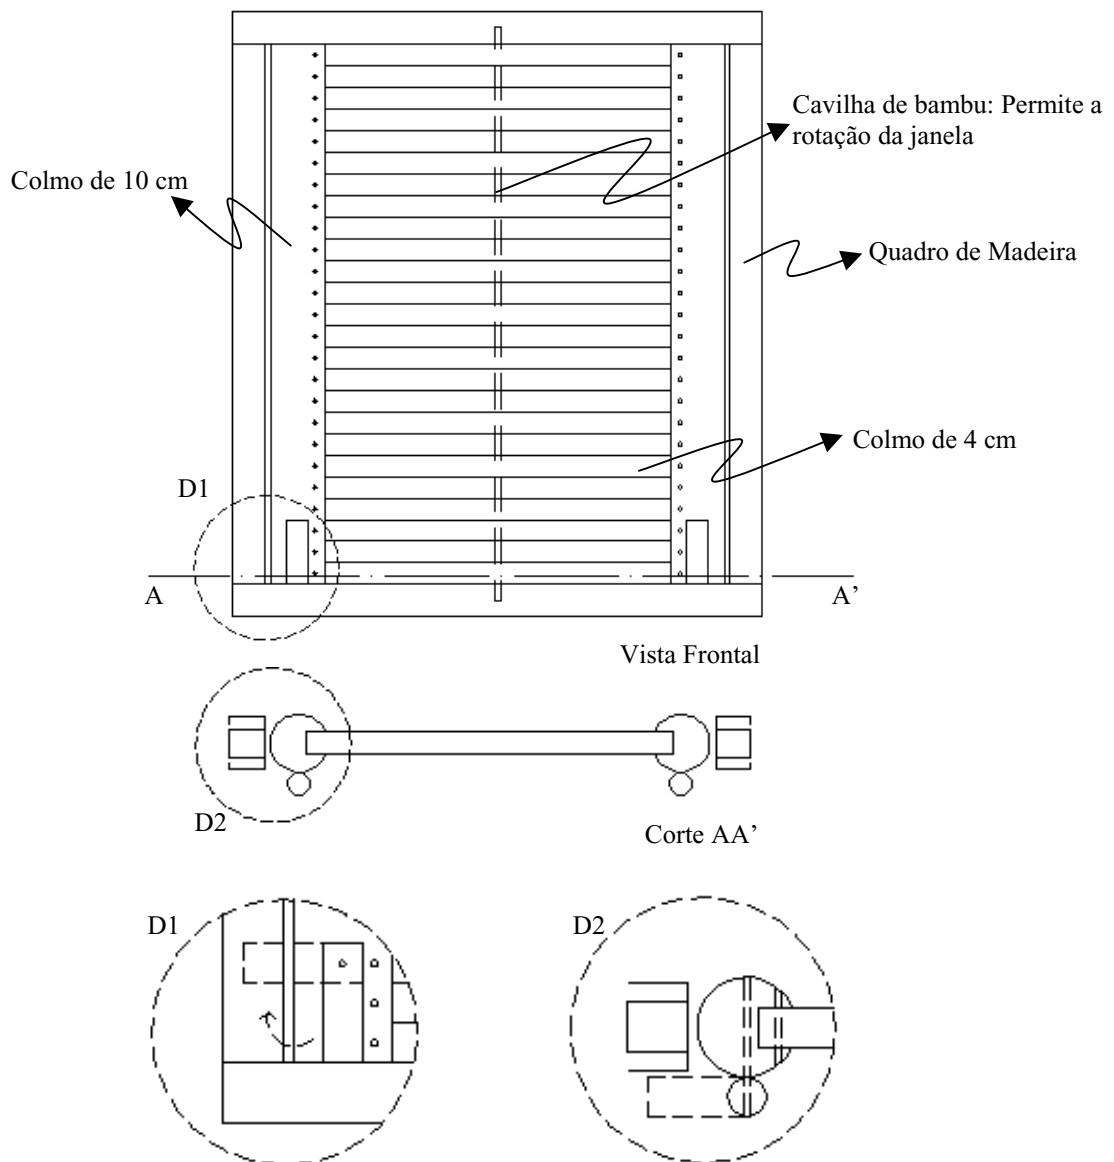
Concepção da janela de bambu (vista frontal, corte AA' e detalhes).
